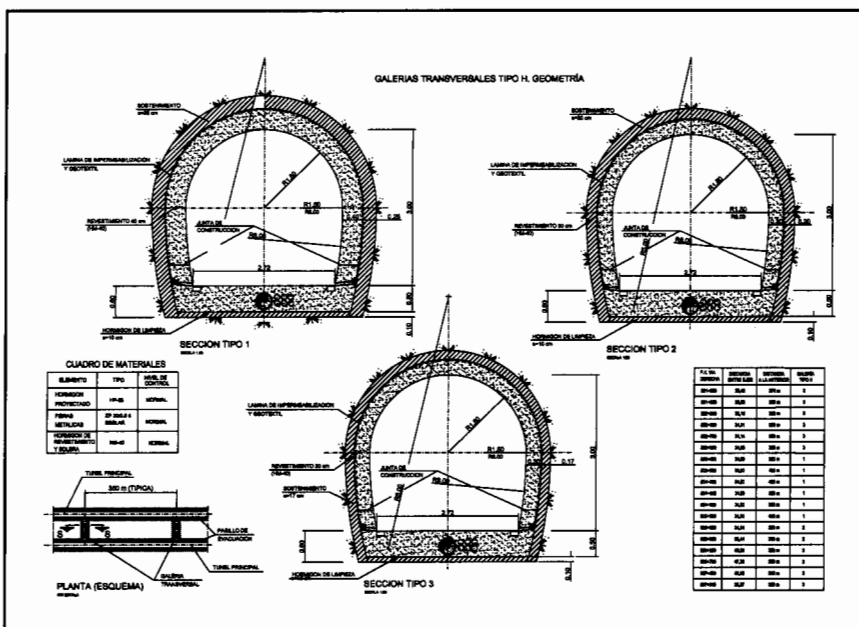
Secciones tipo de las galerías de conexión dependiendo del tipo de terreno en que se ejecutan. Fig. 4. Standard sections of the crossing passages depending on the type of ground.
